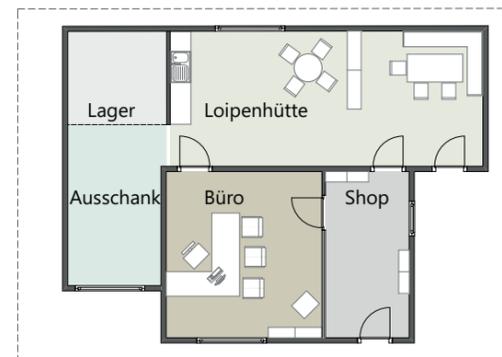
Aktuelles Tourismusbüro Grüner See Grundriss (ca. M 1:200)
